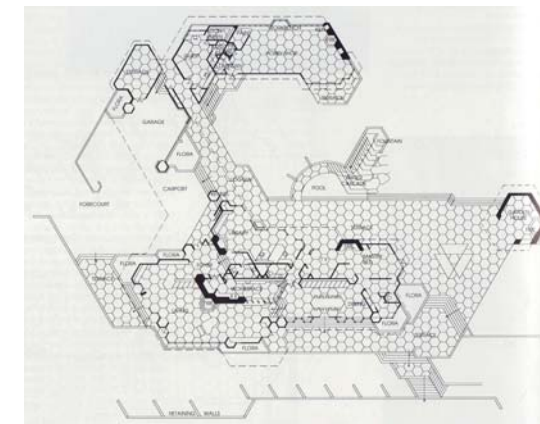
Grundriss Hanna Residence, Honeycomb House, 1936 in Stanford, California (Storrer 1993, 243)
